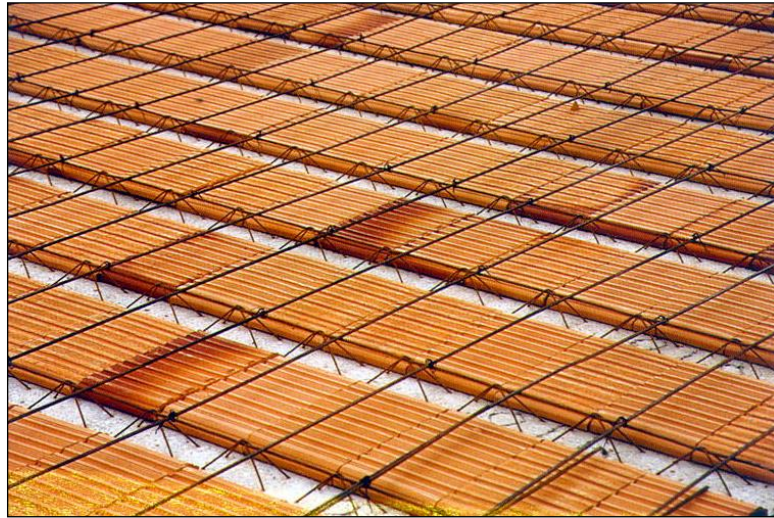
Laje pré-fabricada do tipo treliçada (FAULIM, 1998).
